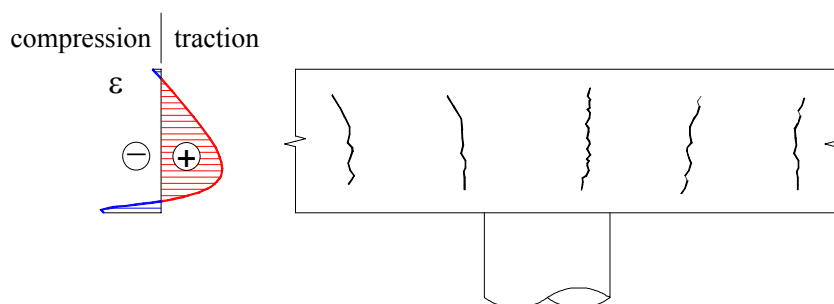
Fissures dans la dalle causées par la déformation entravée
